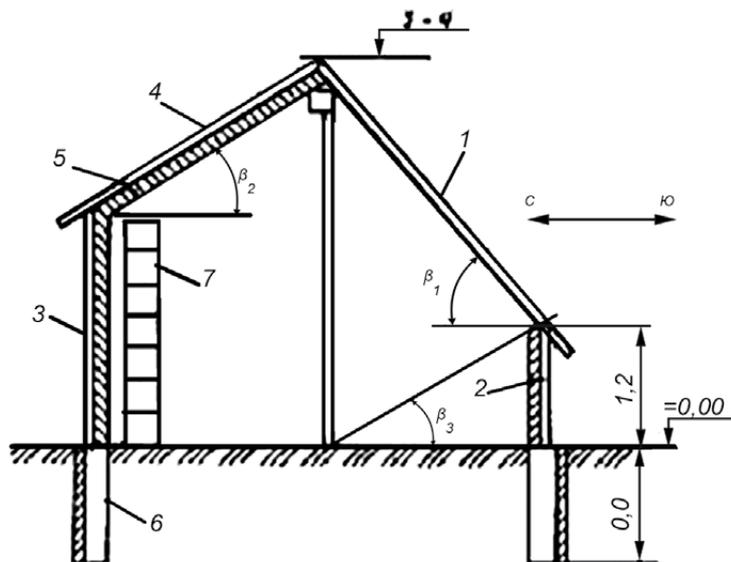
Отдельно стоящая солнечная теплица [142]: 1 – светопрозрачная изоляция; 2 – теплоизолированная передняя стенка; 3 – теплоизолированная северная стенка; 4 – крыша; 5 – теплоизоляция; 6 – теплоизолированный фундамент; 7 – аккумулятор теплоты
